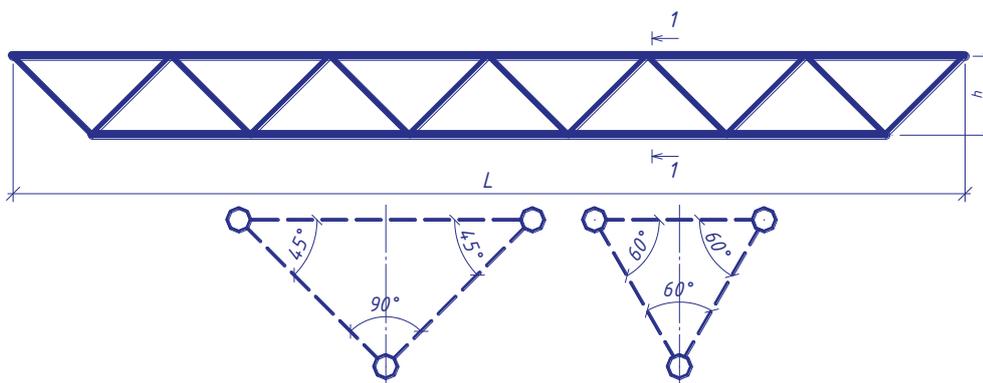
Трёхгранные фермы с различными углами сопряжения плоских ферм
